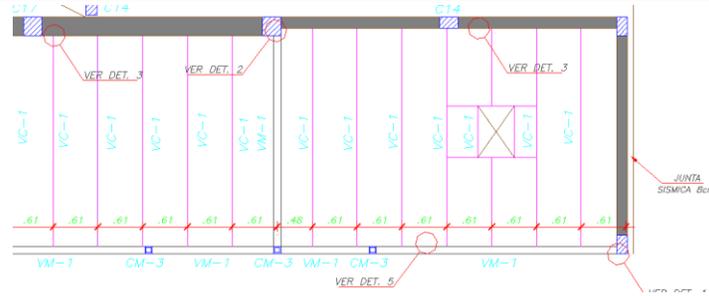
Estructura Metálica - Plano de Techo Metálico.
